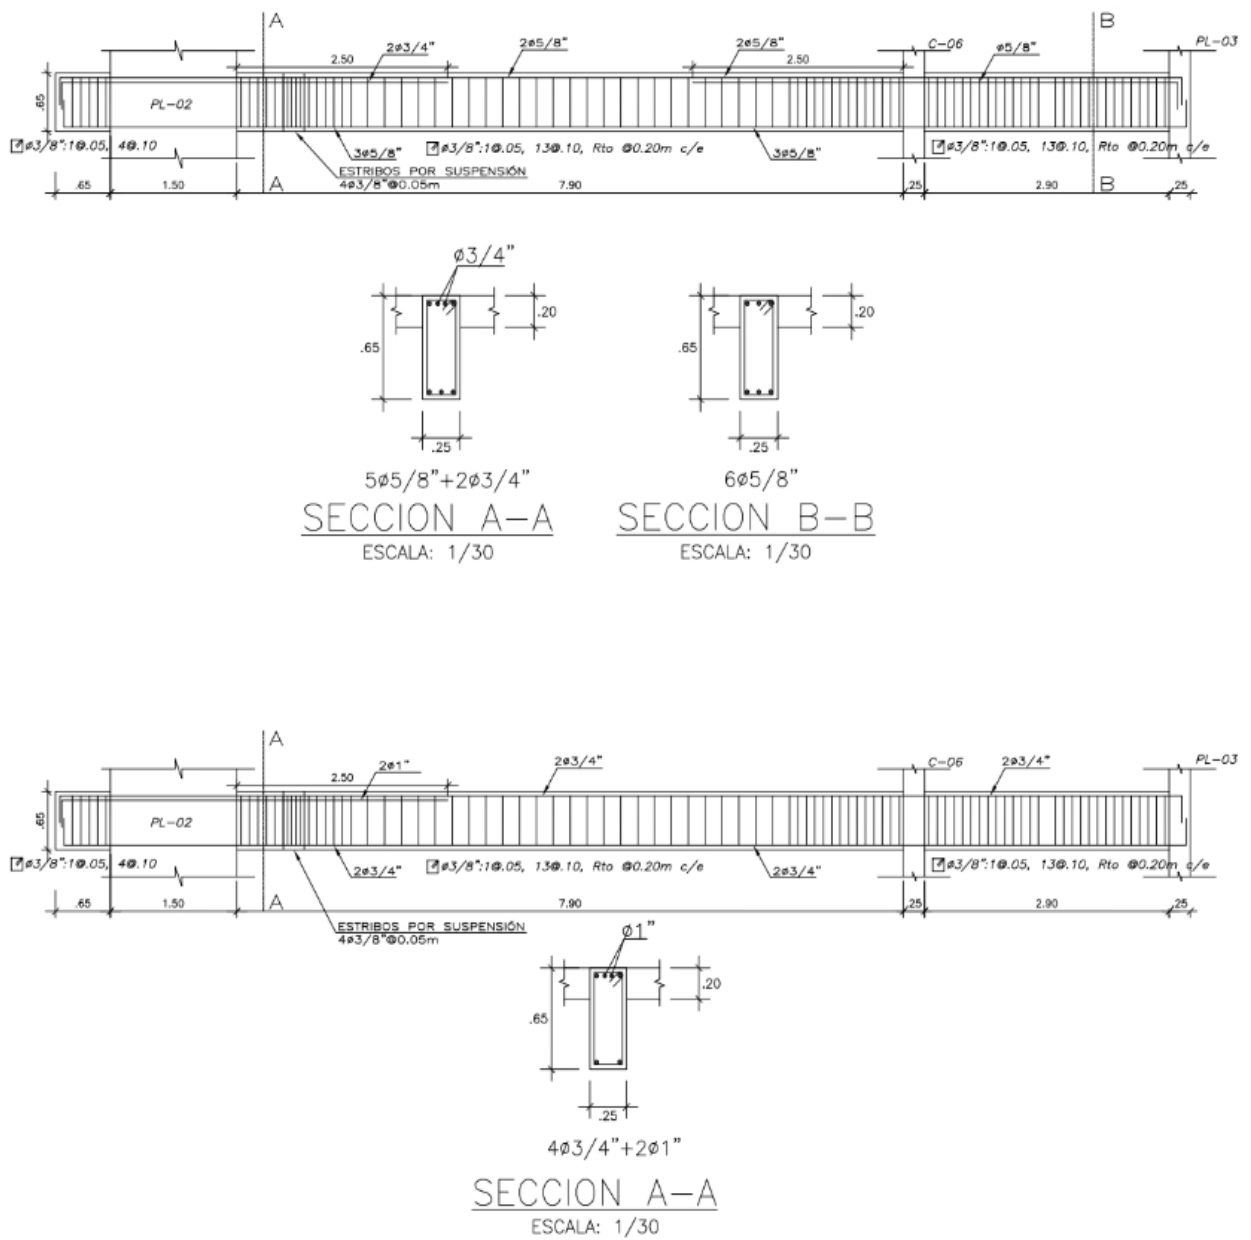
Armado y secciones de las vigas V-102 a la V-107
